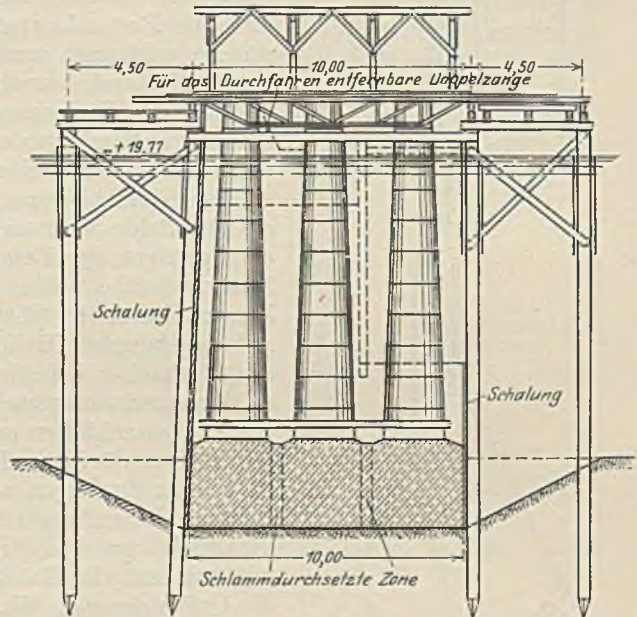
Trichterbetonierung bei dem Bau des Marinekohlenhafens von Holtenu durch 3 nebeneinanderritzende Trichter. Es bildeten sich in der bezeichneten Zone Ablagerungen von Betonschlamm.
